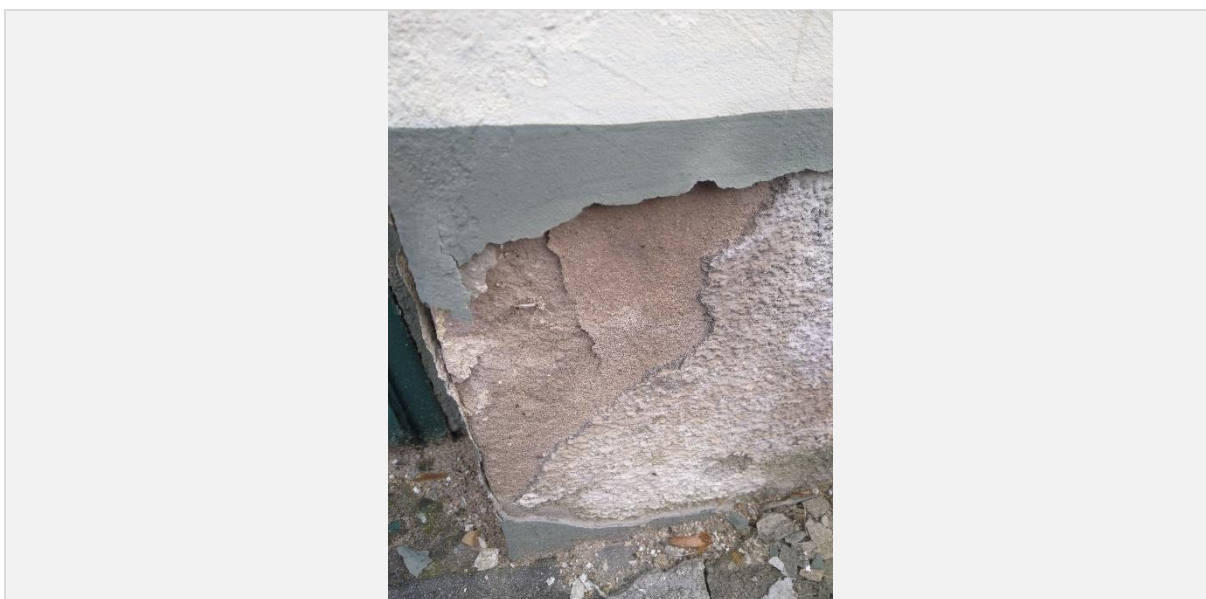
Elewacja frontowa –uszkodzenia powierzchni elewacji przy oknie oraz nad bramą garażową
